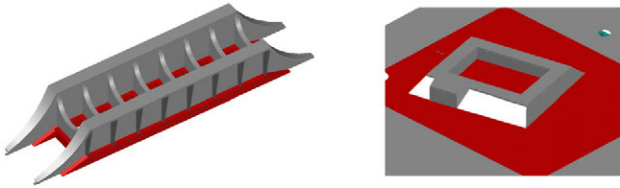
Утяжеление конструкции фундамента (выделено красным) за счет добавления ВЗМ (а); местное увеличение толщины перекрытия под фундаментом (б)
